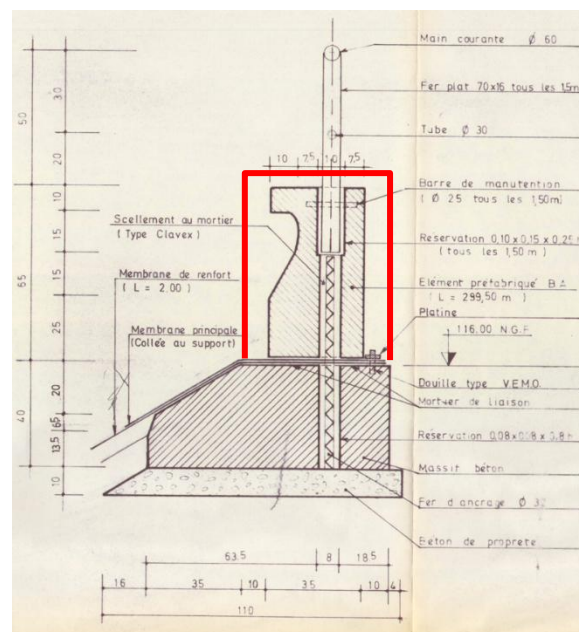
Coupe type du muret pare-vague - Plan de projet de la construction
